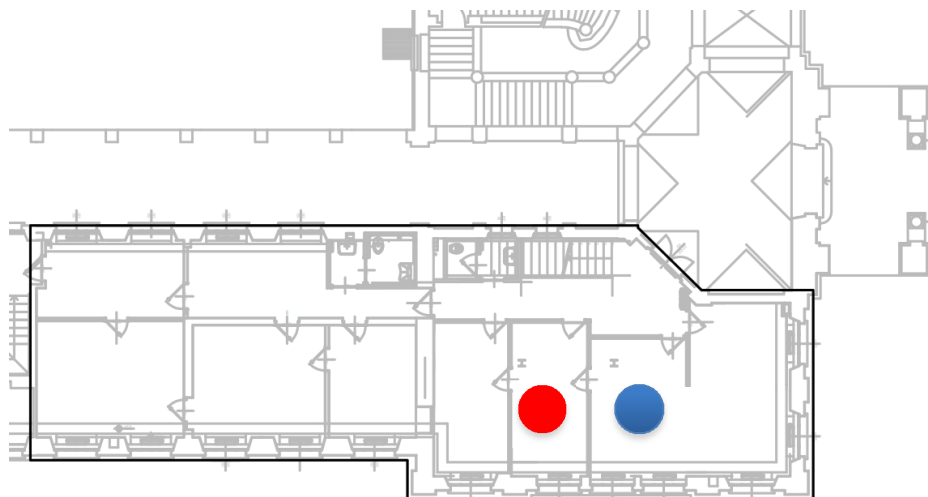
Ingrandimento della zona interessata Pianta Piano Terra
